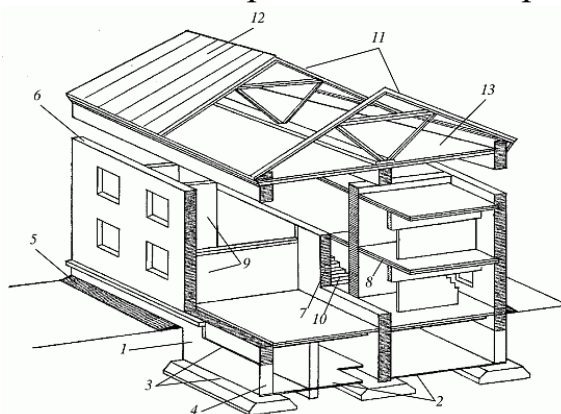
1. Конструктивные элементы двухэтажного дома: 1 – фундамент; 2 – пол подвала; 3 – гидроизоляция; 4 – стены подвала; 5 – отмостка; 6 – наружные стены; 7 – внутренние стены; 8 – междуэтажные перекрытия; 9 – перегородки; 10 – лестница; 11 – стропила; 12 – кровля; 13 – чердачное перекрытие
